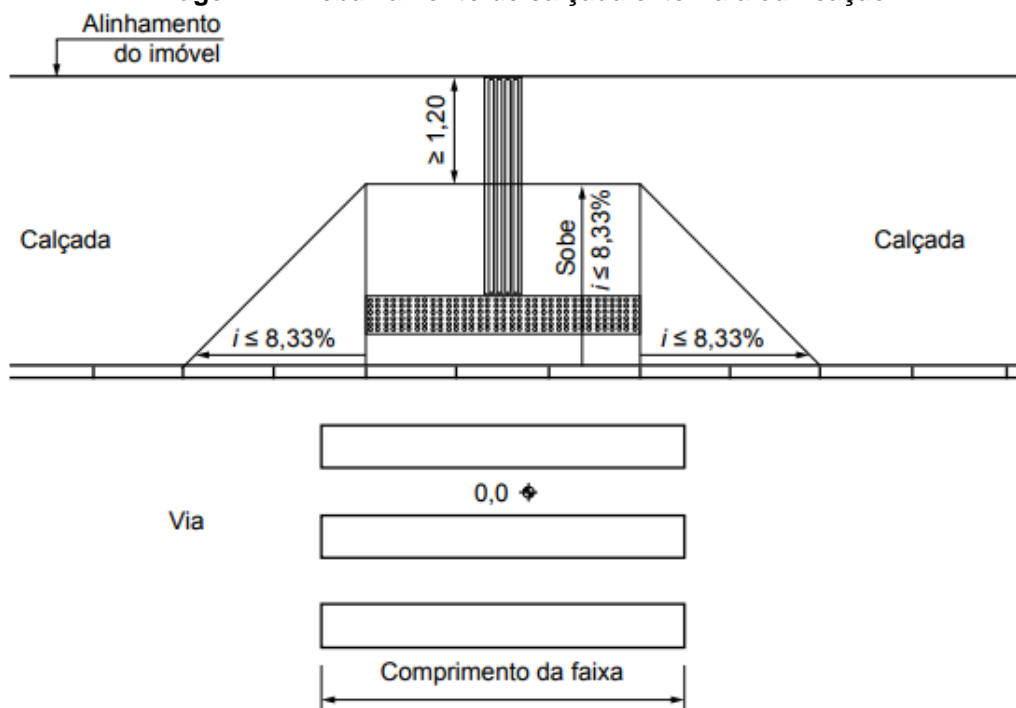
Modelo de rebaixamento de calçada externa a edificação
